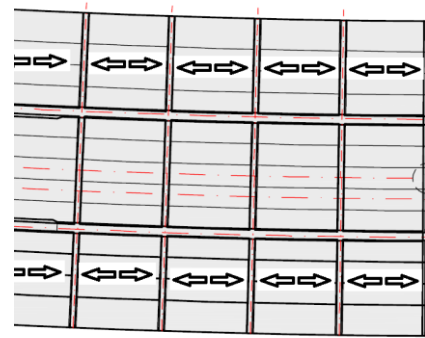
Representação esquemática da distribuição das cargas em planta entre travessas
